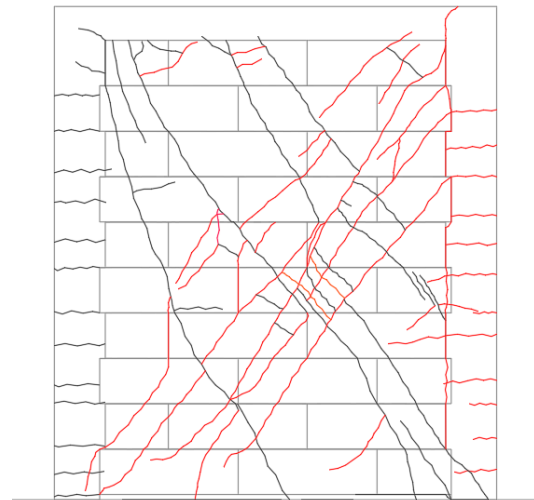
Patrón de agrietamiento final del muro M-1.23-7.2
